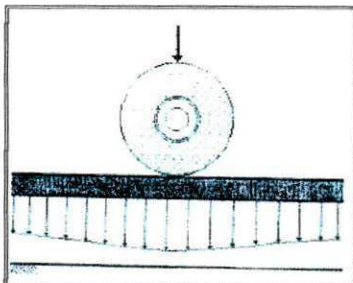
Distribuição do carregamento em uma placa do pavimento rígido
